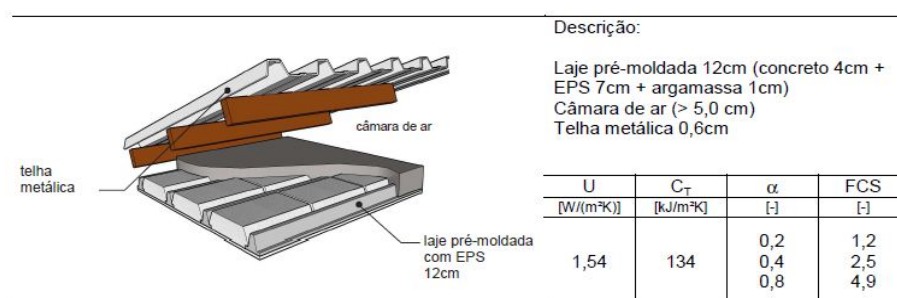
Telha metálica com laje pré-moldada 12,0cm feito de concreto, EPS e argamassa (LabEEE 2010)
